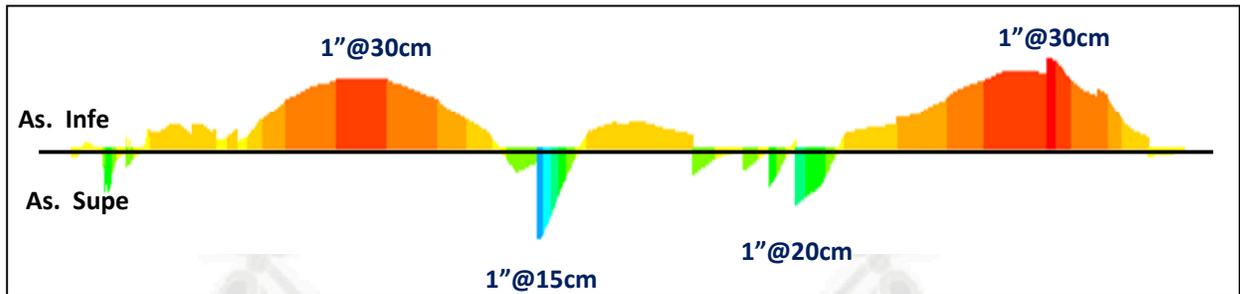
Refuerzo Superior e Inferior en la Dirección x-x de la Platea.
